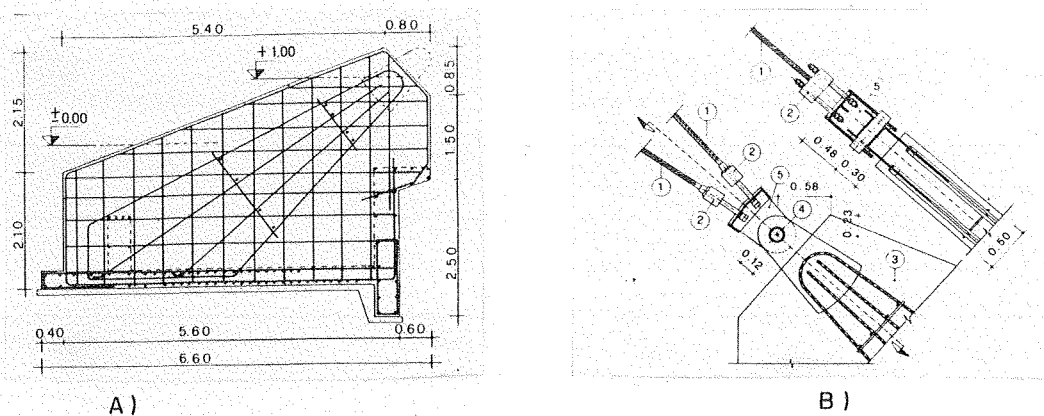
A) Maciço de ancoragem para os tirantes - Corte vertical; B) Ancoragem ao solo dos tirantes: Elevação e corte. 1) Tirantes; 2) Arranques; 3) Maciço; 4) Cavilha 120mm; 5) Peça em aço soldado.
